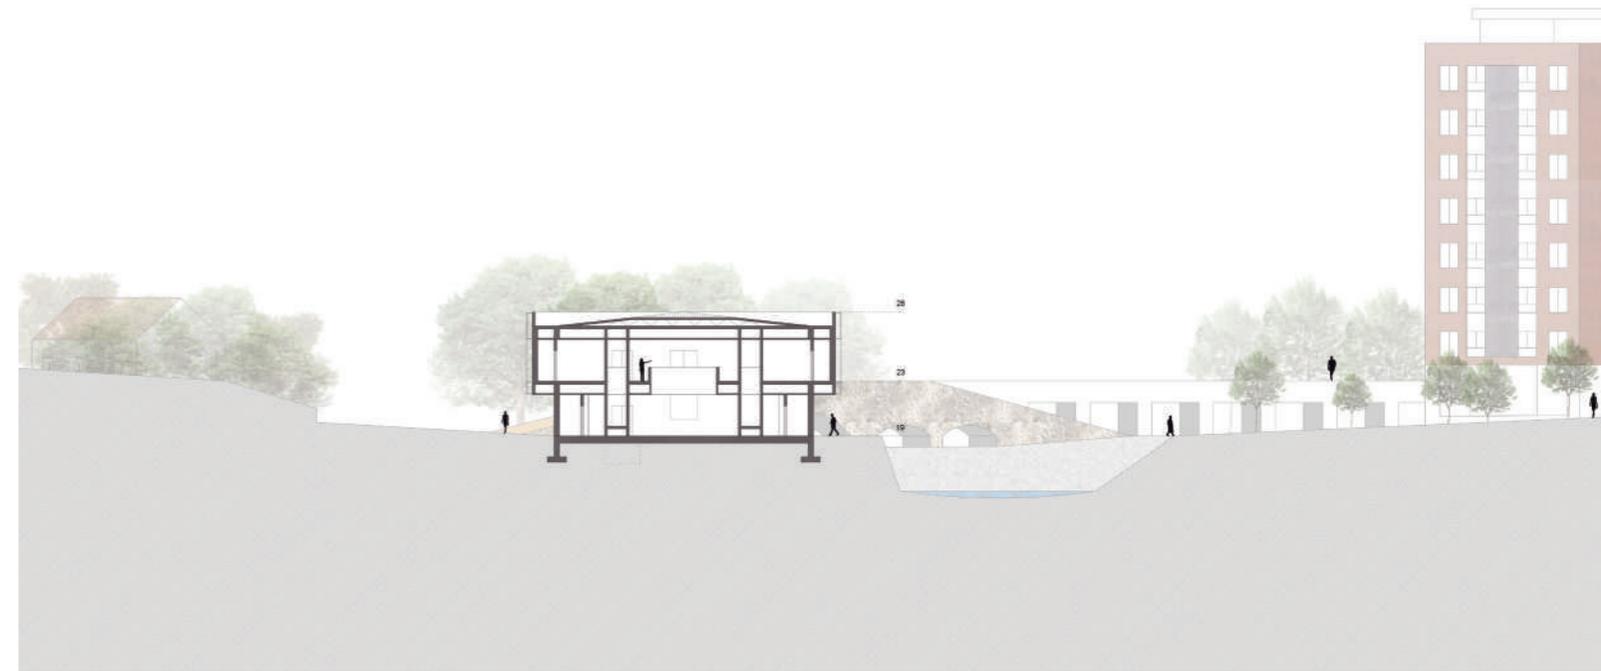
Corte Transversal A-A' (redução da escala 1:200)
